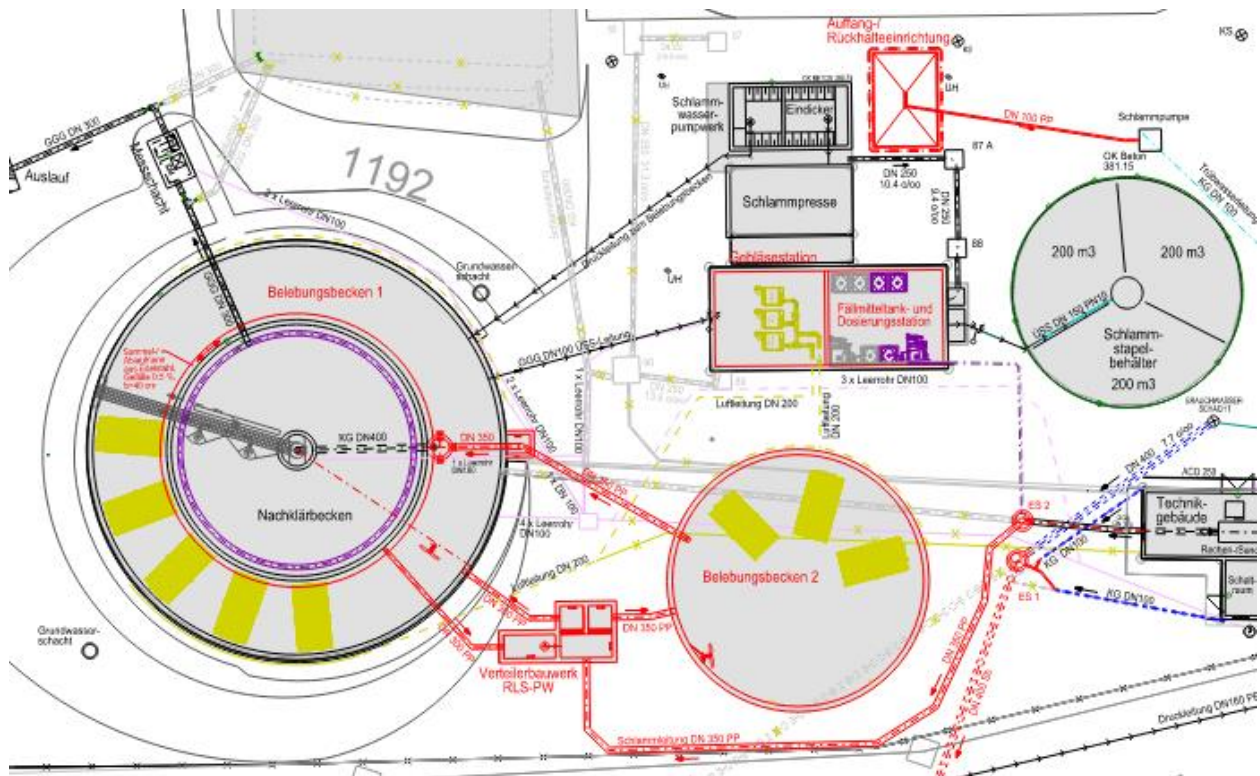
Auszug aus dem Lageplan mit baulichen Erweiterungen
